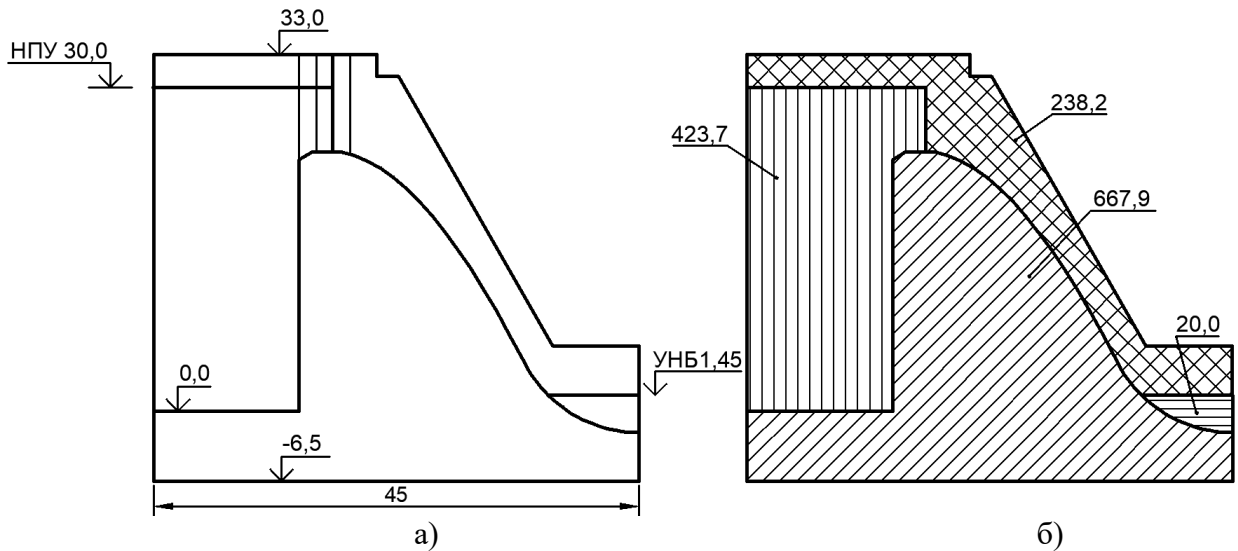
Исходные данные к расчёту нагрузок на бетонную водосливную плотину
